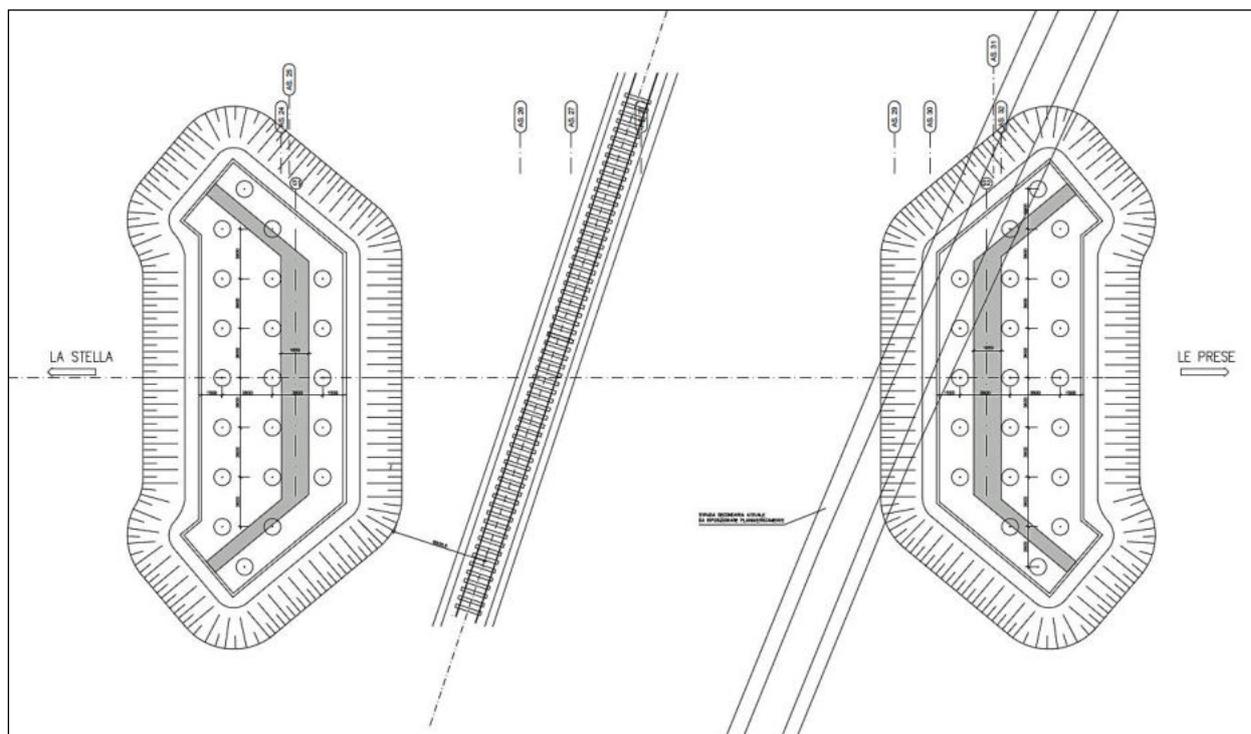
/2 Ponte sulla ferrovia – Prospetto
